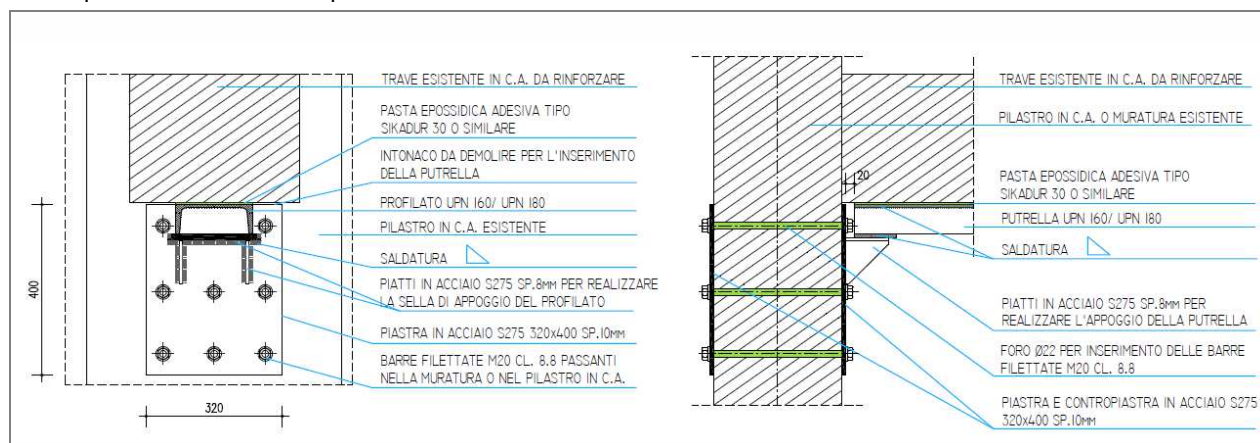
intervento di rinforzo delle travi in c.a. con inserimento ad intradosso di profilati in acciaio
